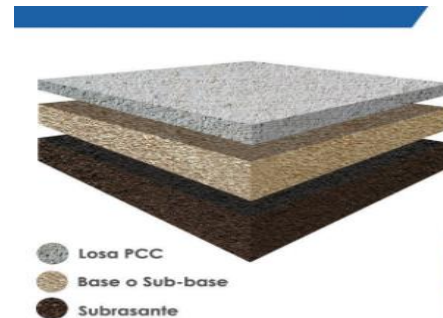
Estructura de un pavimento rígido. Fuente: @solestudiosing (2017).
